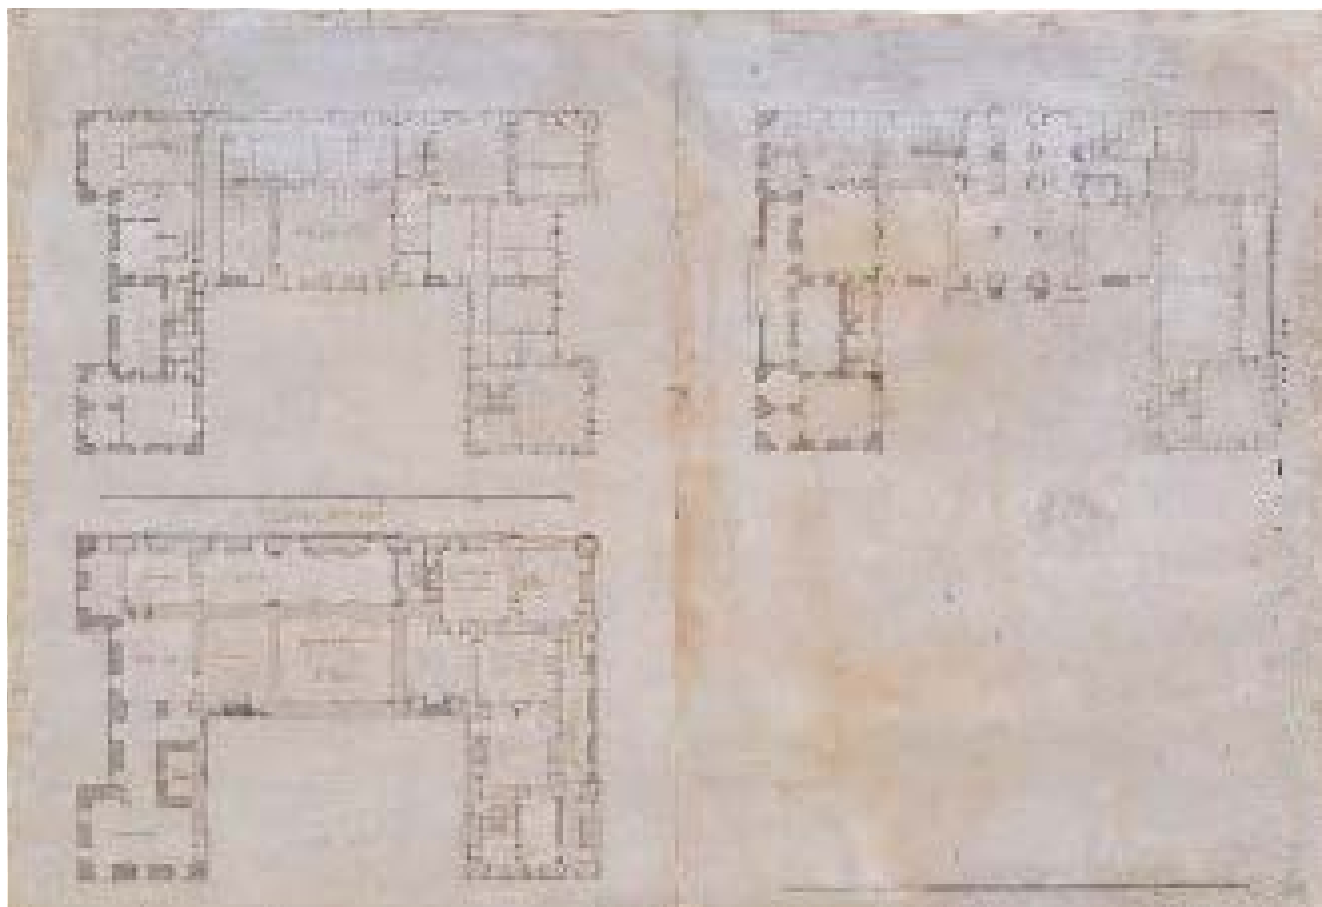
[GASTALDI], *Pianta del terzo e ultimo Piano, pianta de' sotterranei, Pianta del pian terreno tendente al secondo piano ove si distingue col rosso l'esistente col nero il progetto di nuovo*, [1740] (ASCGovone, s.c. – su concessione del Comune di Govone).
